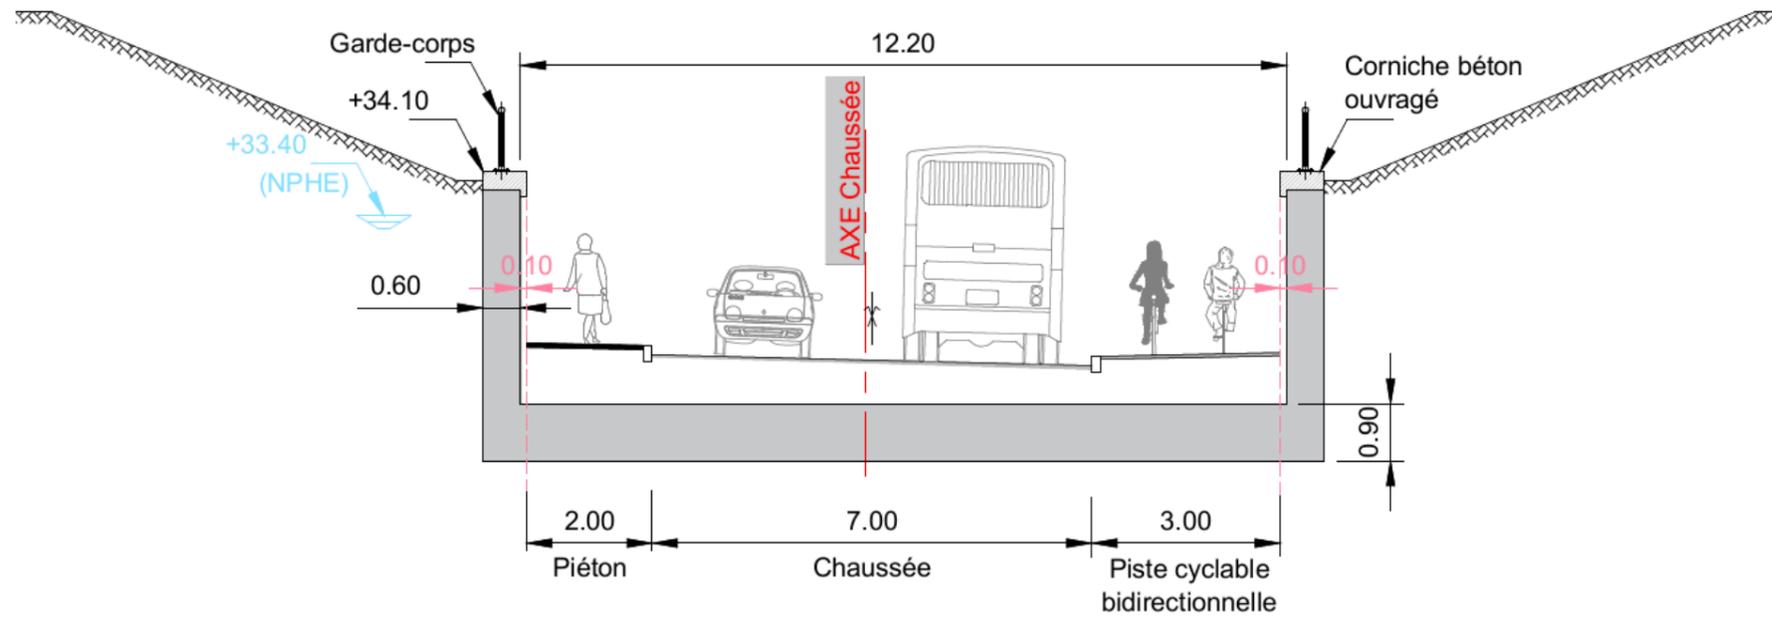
COUPE TRANSVERSALE SUIVANT L'AXE DU PRO
